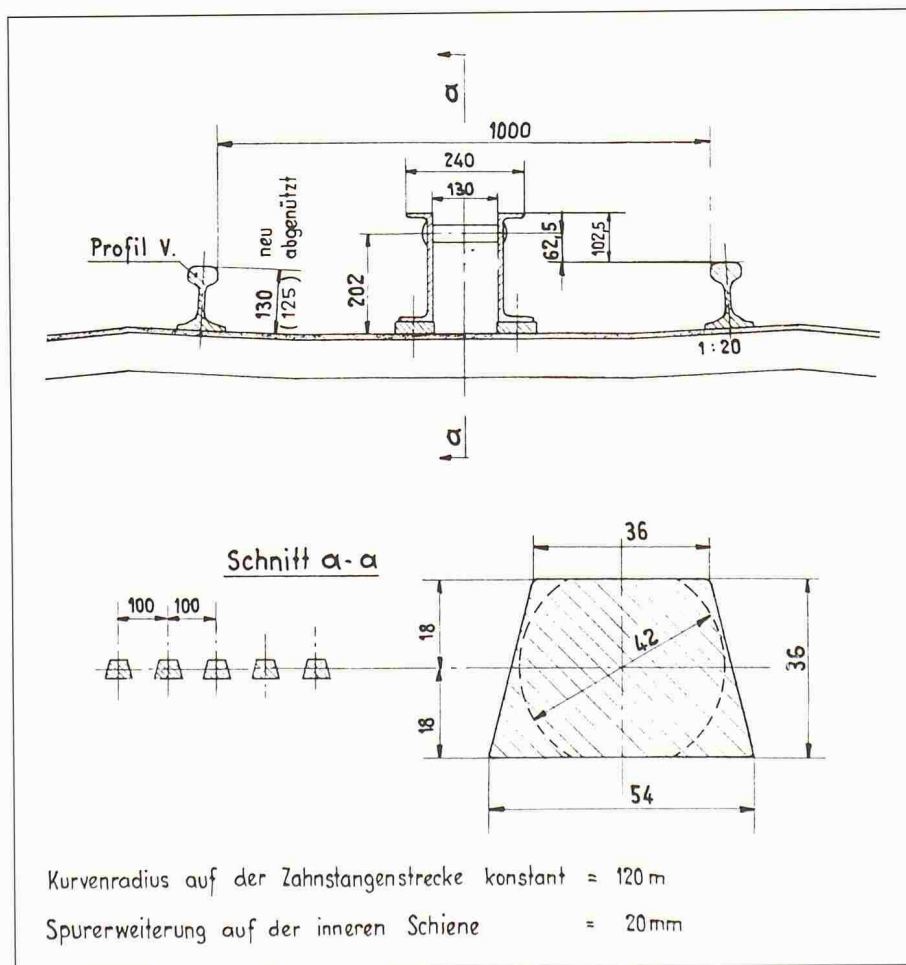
Konstruktionszeichnung der Riggenbachschen Zahnstangen
